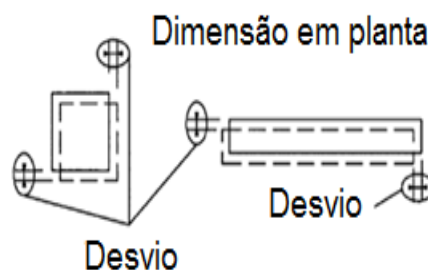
Posição em planta (adaptado da Fig. R4.2.1 [11]).
